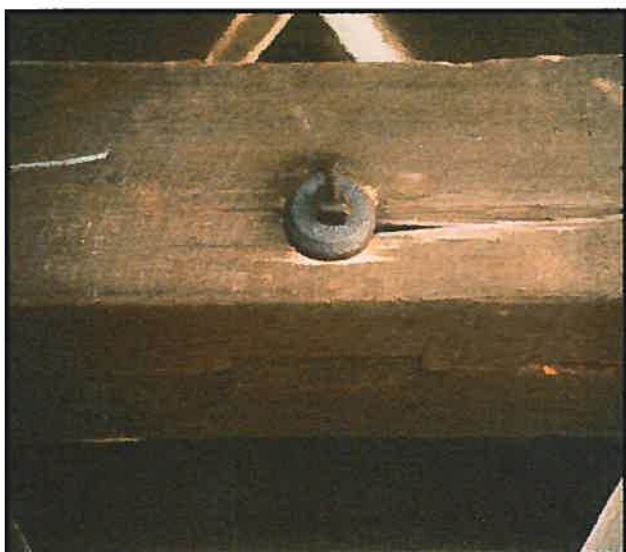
Exemple de clef d'assemblage utilisé pour la construction du pont McVetty-McKerry (61-18-08).
